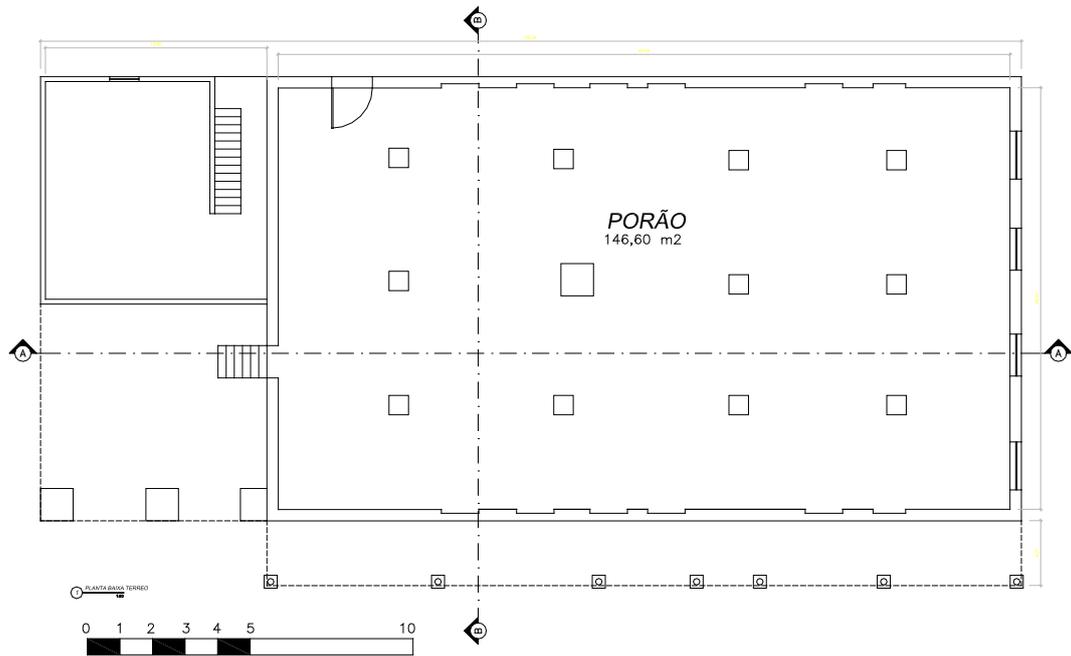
Planta primeiro pavimento - porão - Casa Rambalducci
